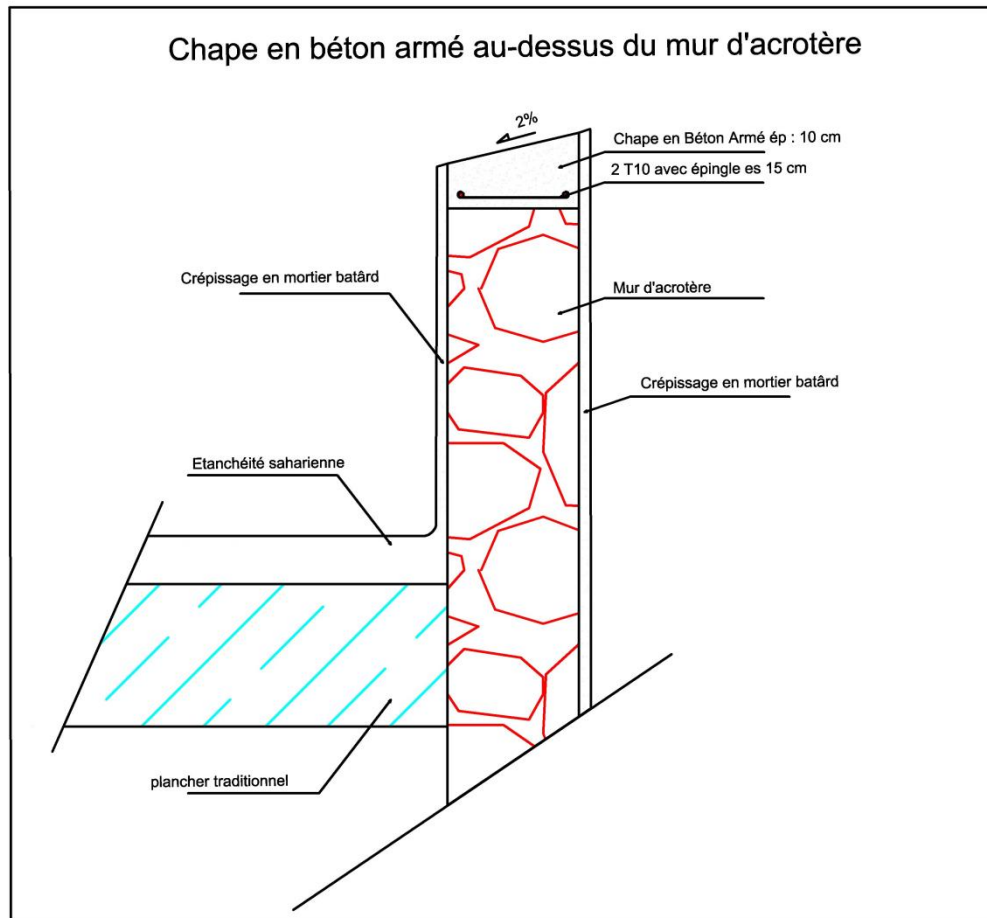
Chape en Béton Armé au-dessus du mur d'acrotère. Source : Auteurs
